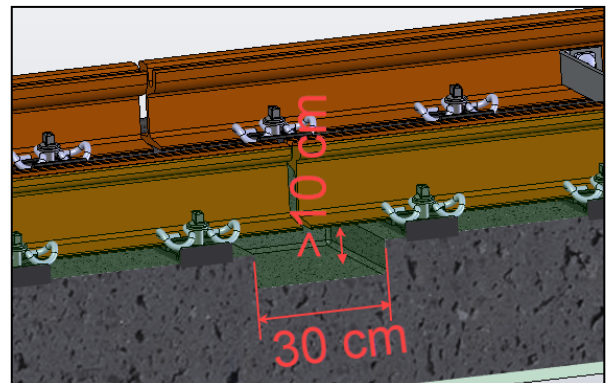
Abmessung der Aussparung für Schweißen im Thermitverfahren
